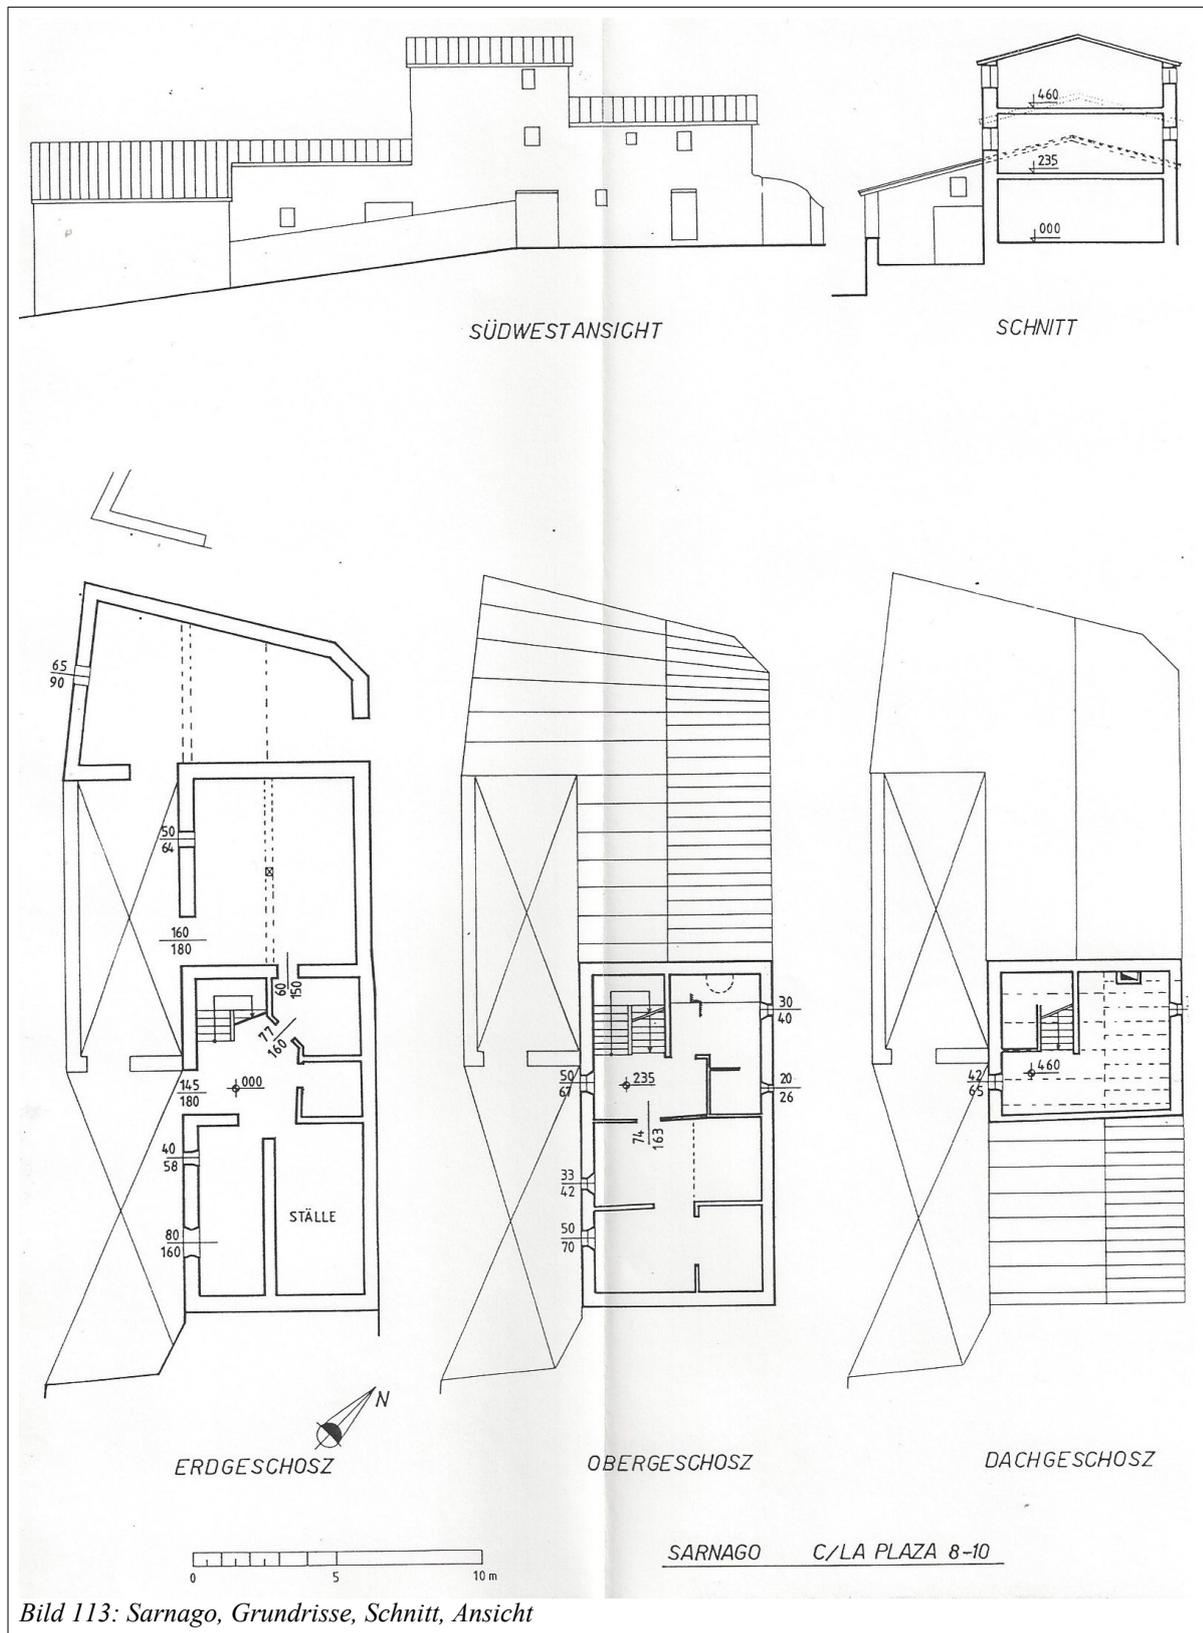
Sarnago, Grundrisse, Schnitt, Ansicht
